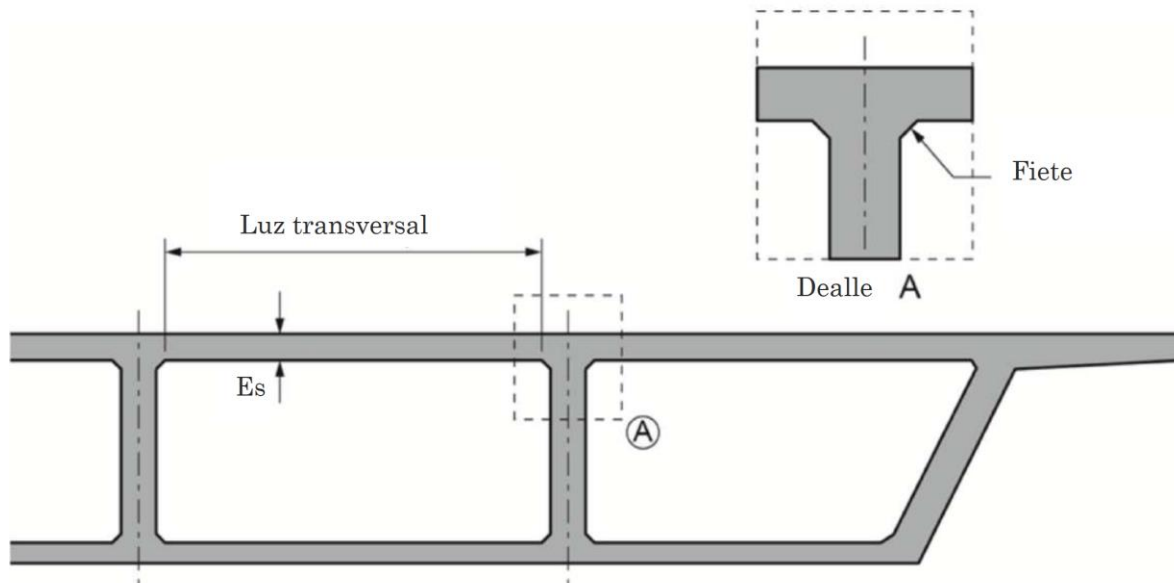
Sección transversal de voladizo de viga cajón (Fuente: [12]).
